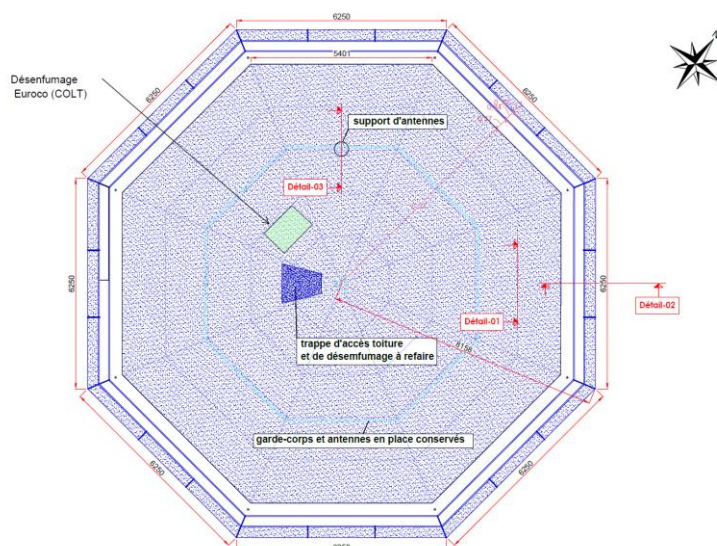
plan de toiture, extrait du DOE du projet de rénovation de 2022
